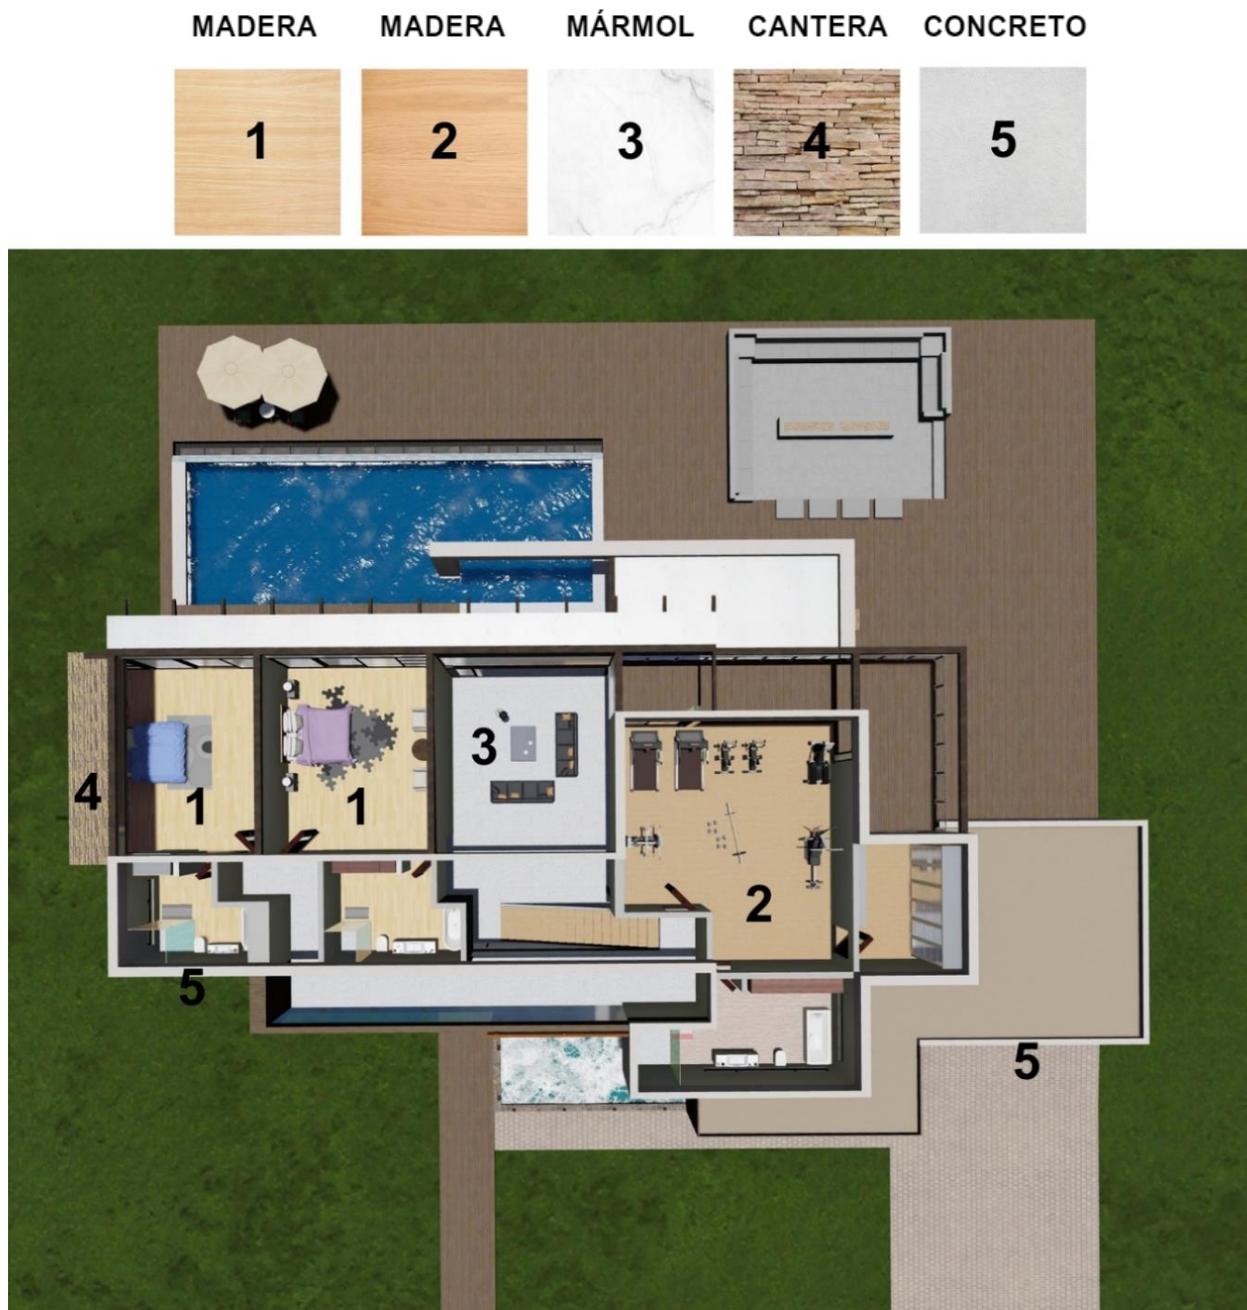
, Diagrama de Planta arquitectónica, Planta Alta, materialidad, creación propia.
